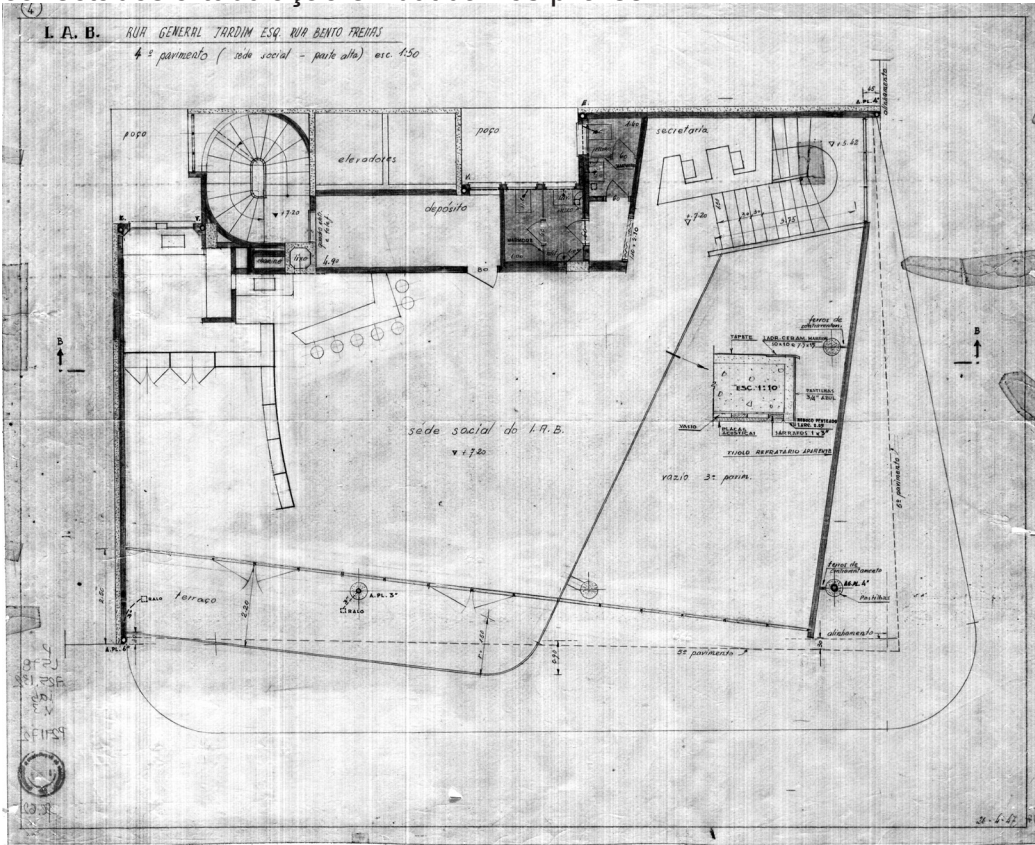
Projeto executivo original - Planta do Quarto Pavimento - 1:200
